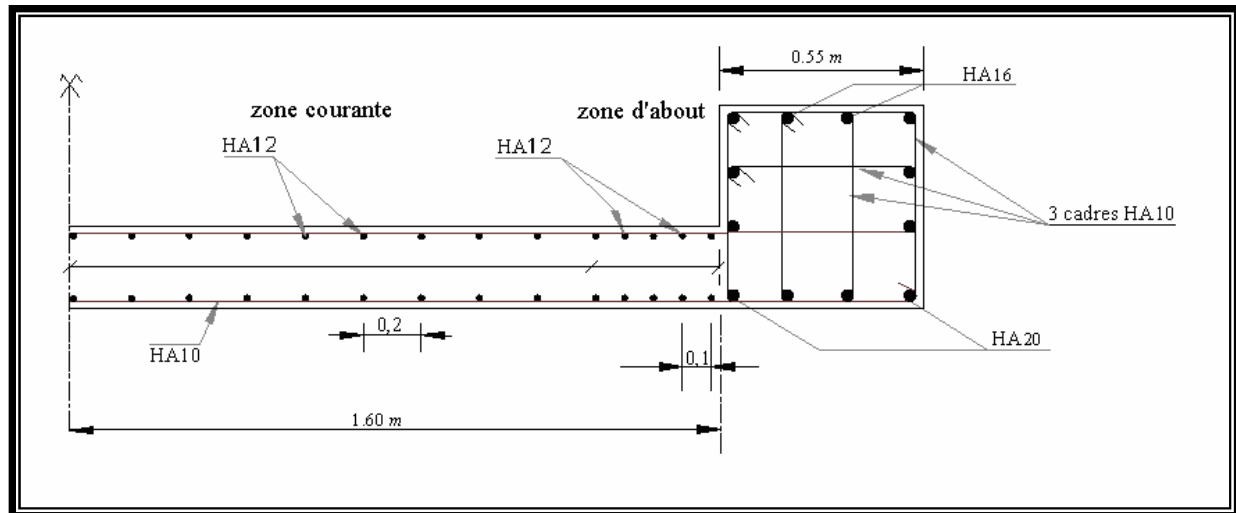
Croquis de ferraillage longitudinal du voile v1
